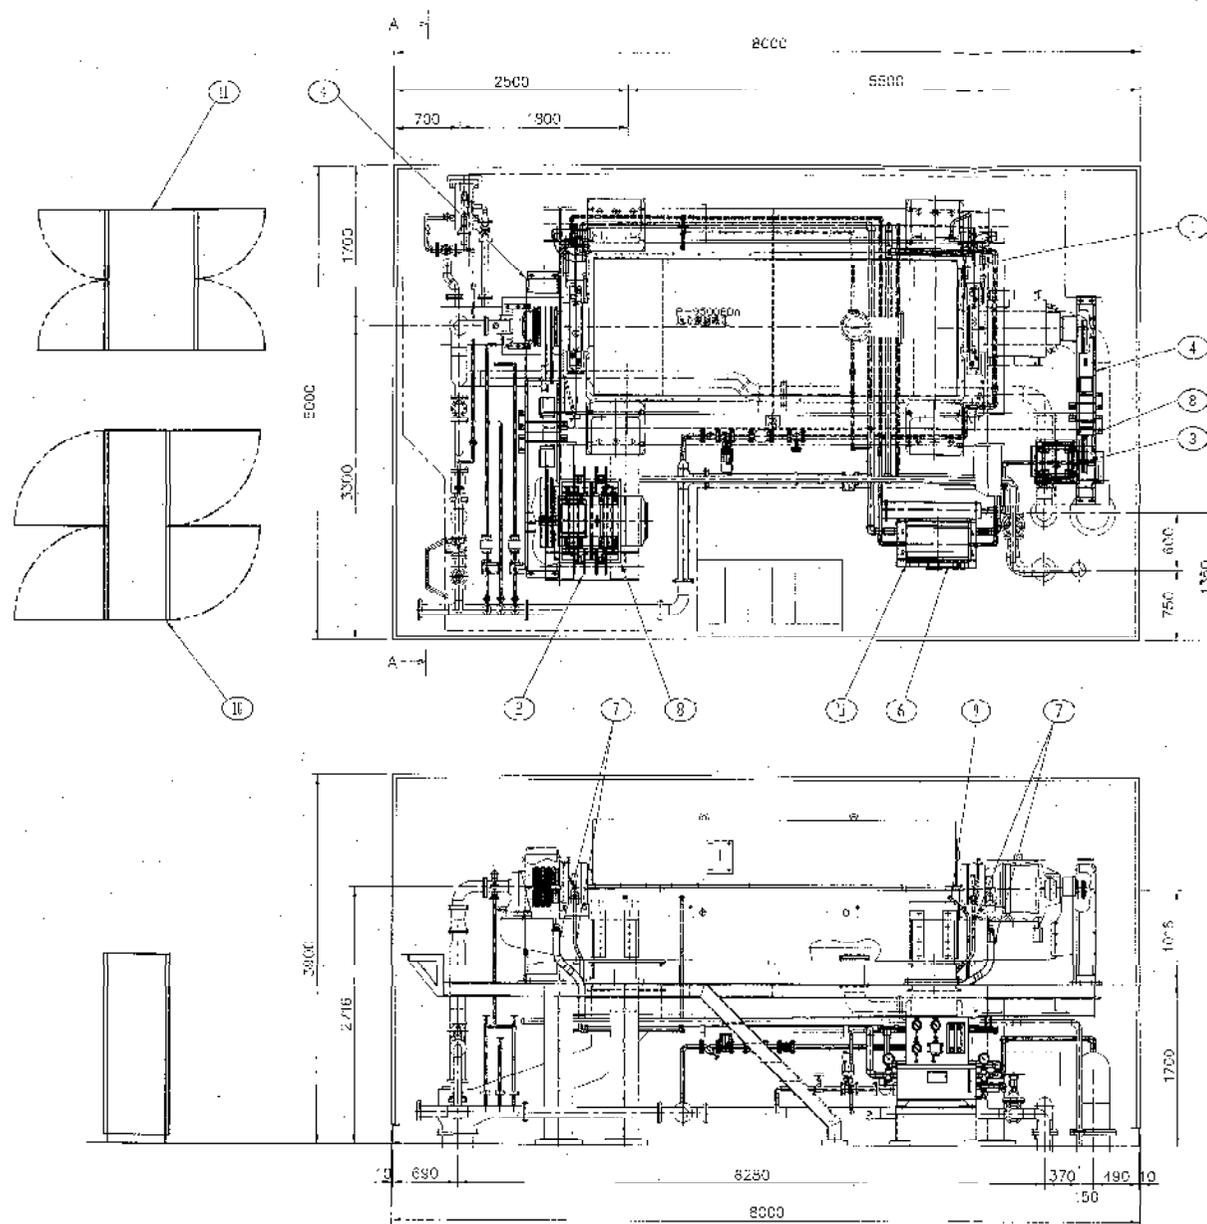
汚泥濃縮棟2階 平面図 図番 3
